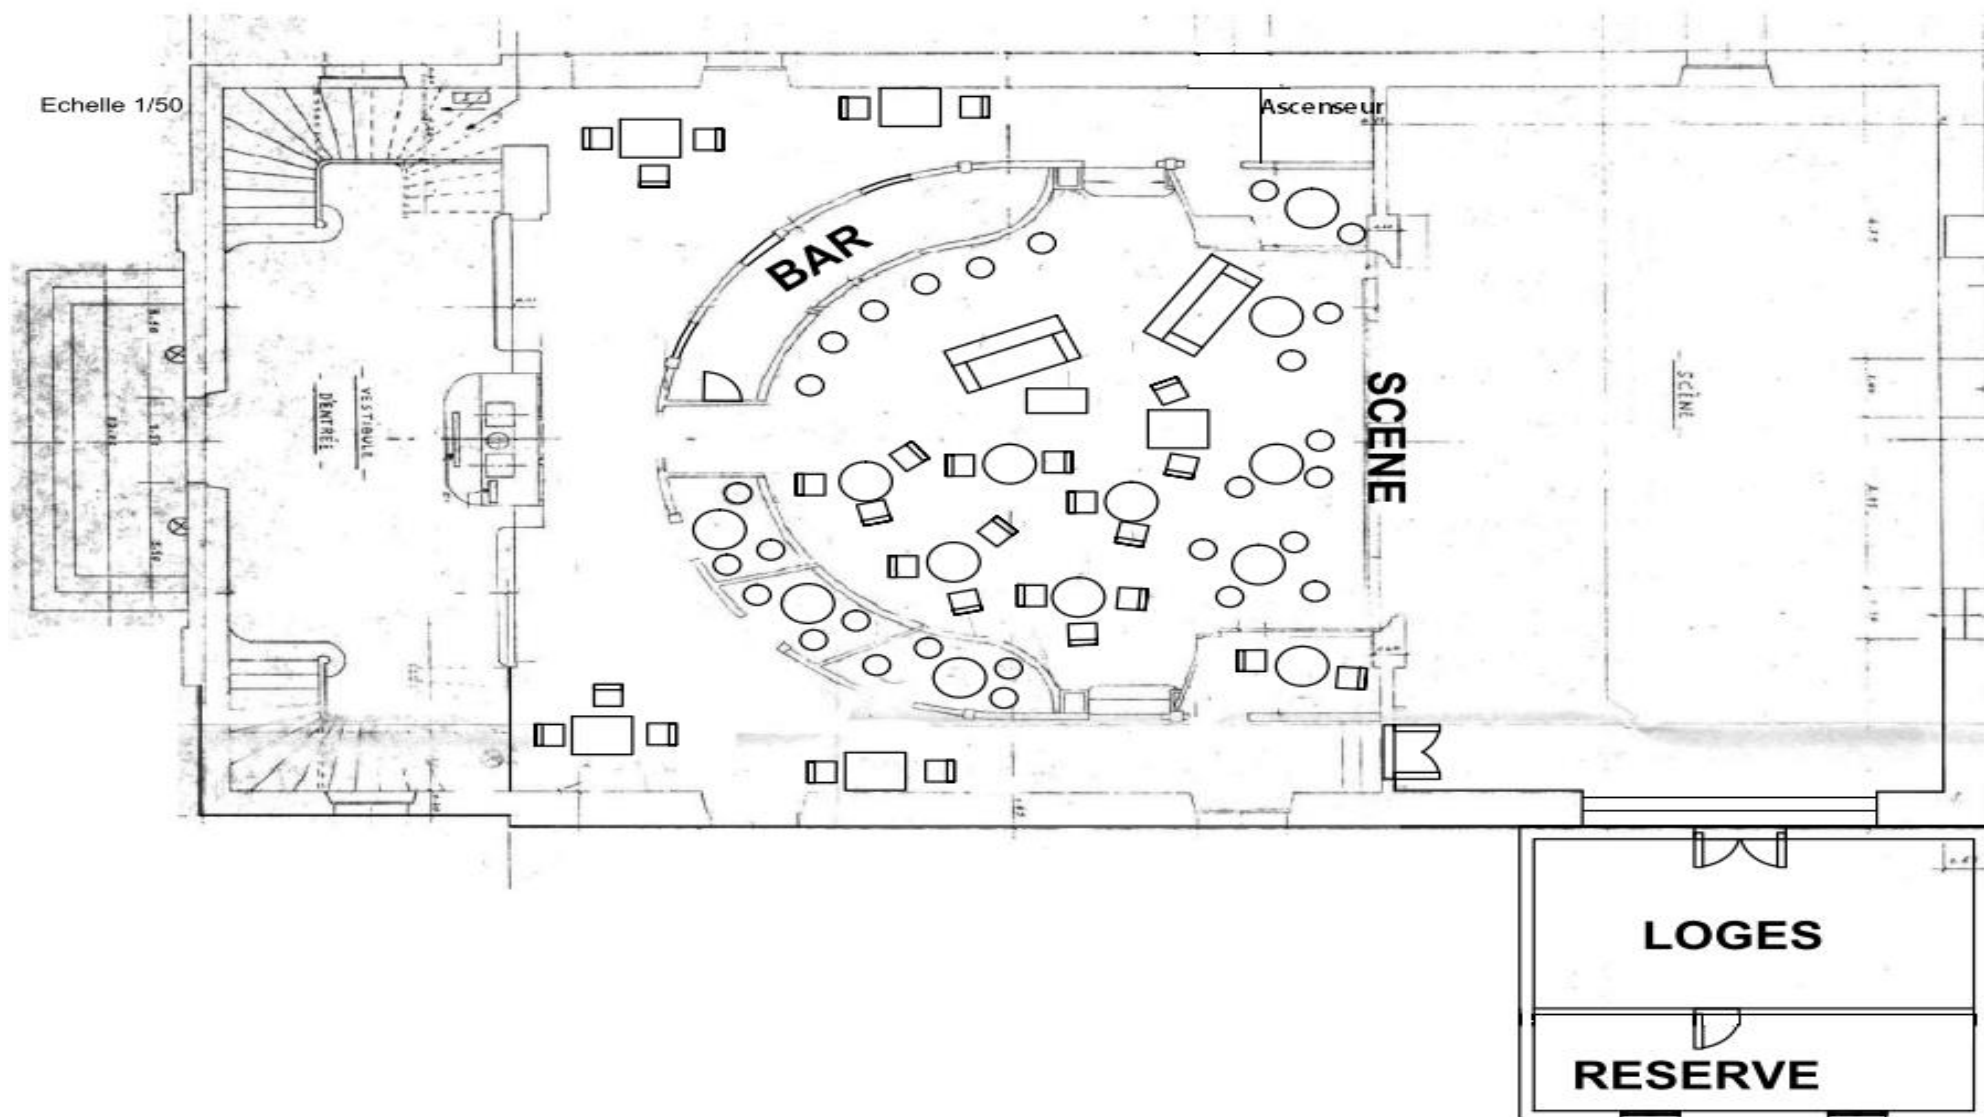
Plan du rez-de-chaussée, suite à la rénovation (source : réalisation personnelle, 2013)
